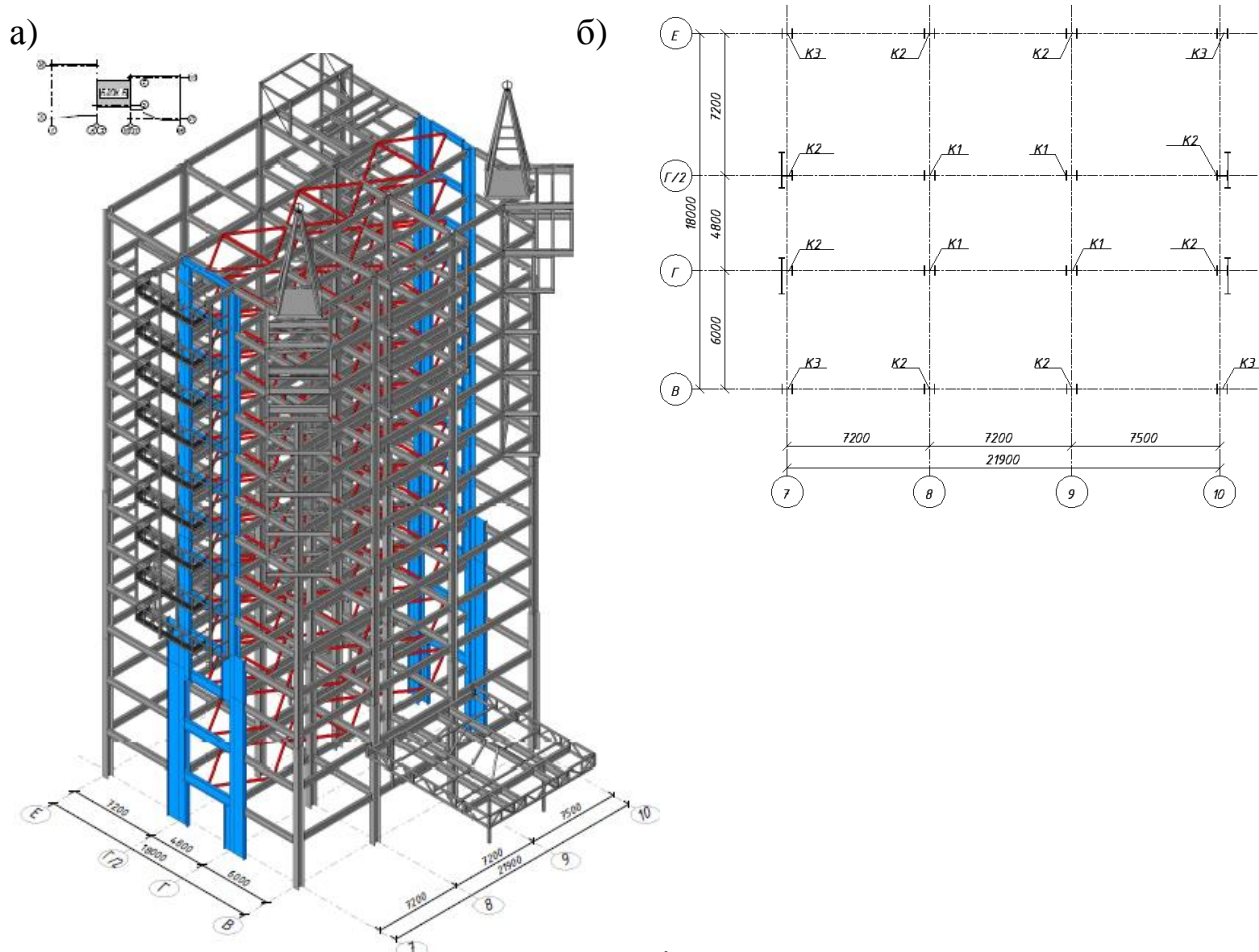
а) Пространственная схема каркаса, цветом выделены горизонтальные связи и связевые рамы; б) план колонн на отм. + 0.000.
